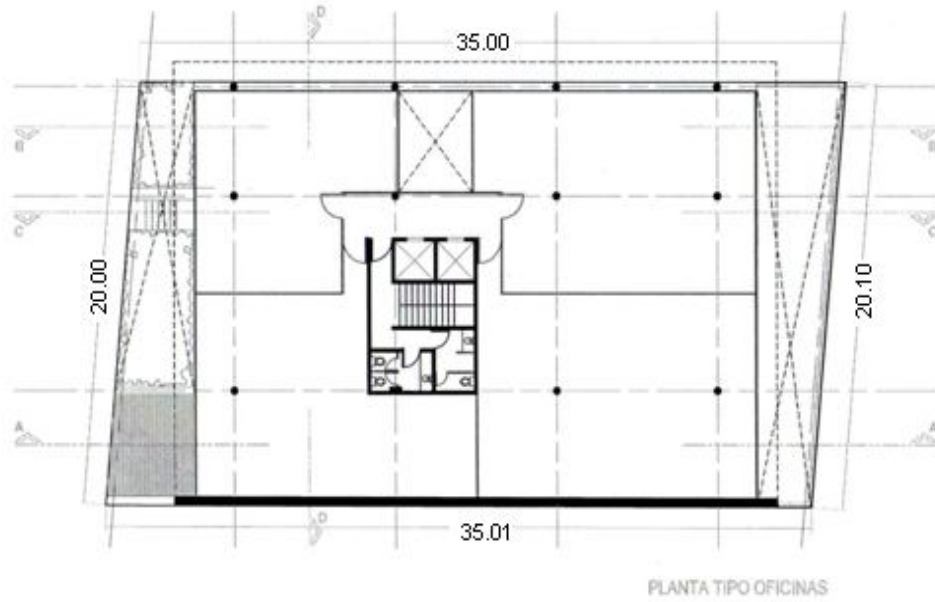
SEMBRADO DE ESTRUCTURAS PLANTA DE OFICINAS
